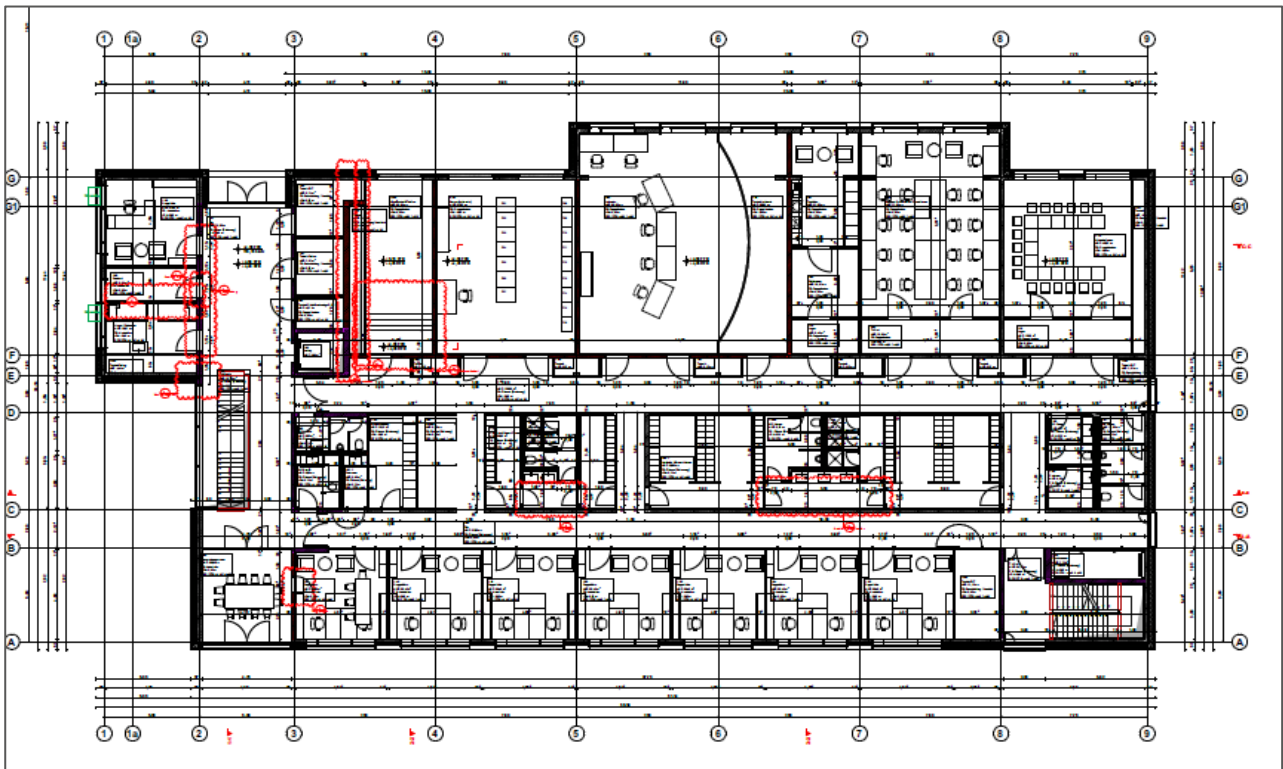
Labor- und Verwaltungsgebäude, Planauszug Grundriss 1. Obergeschoss
